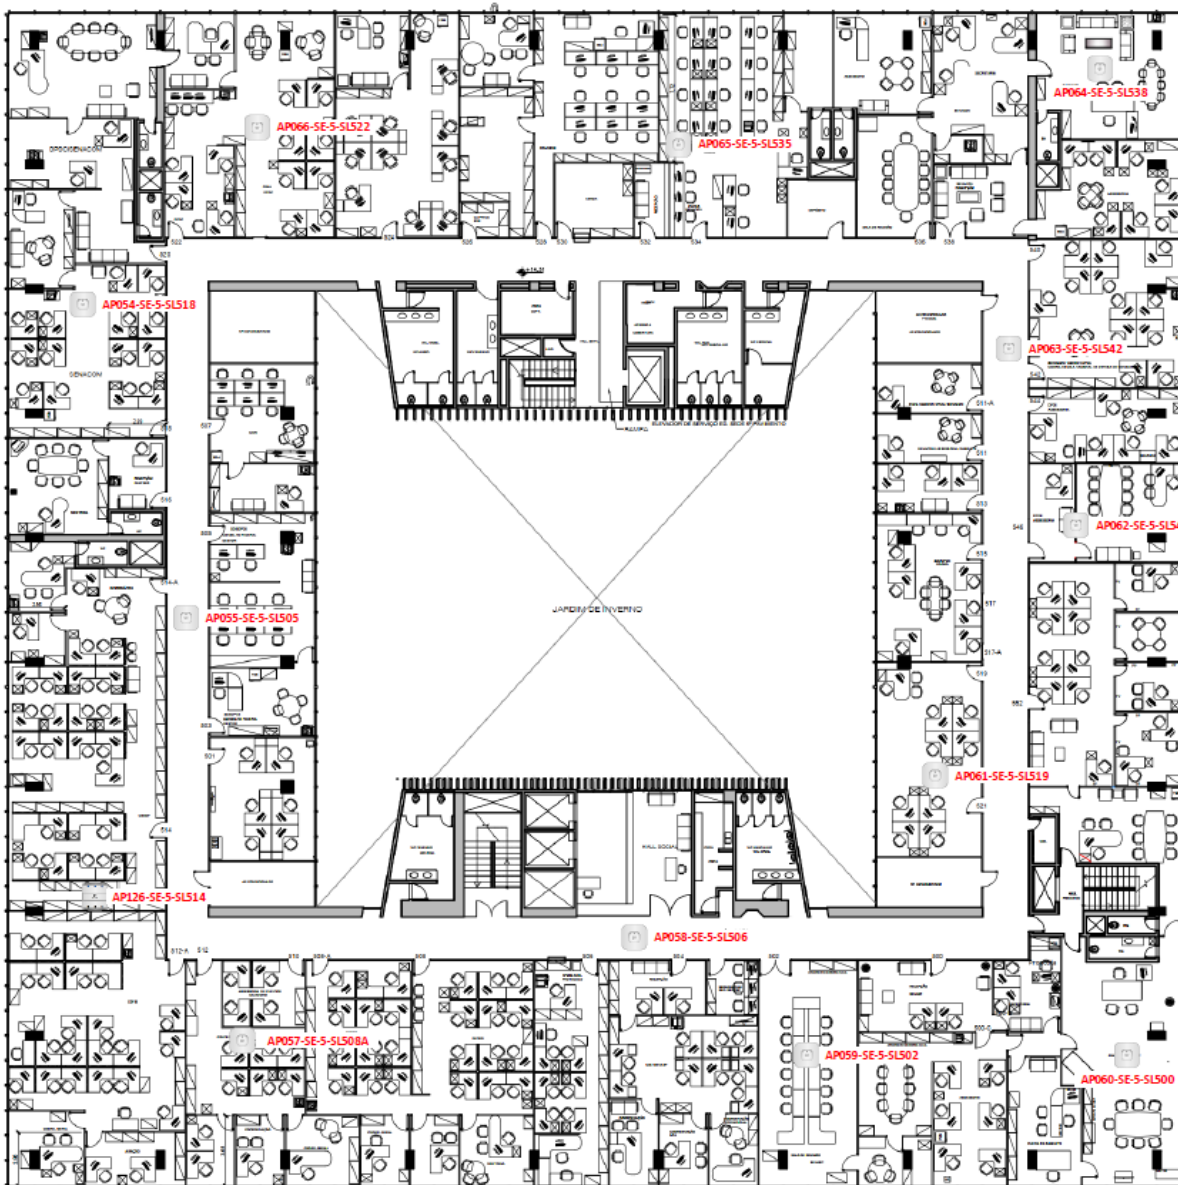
Planta Baixa MJSP - SEDE - Localização Access Point
